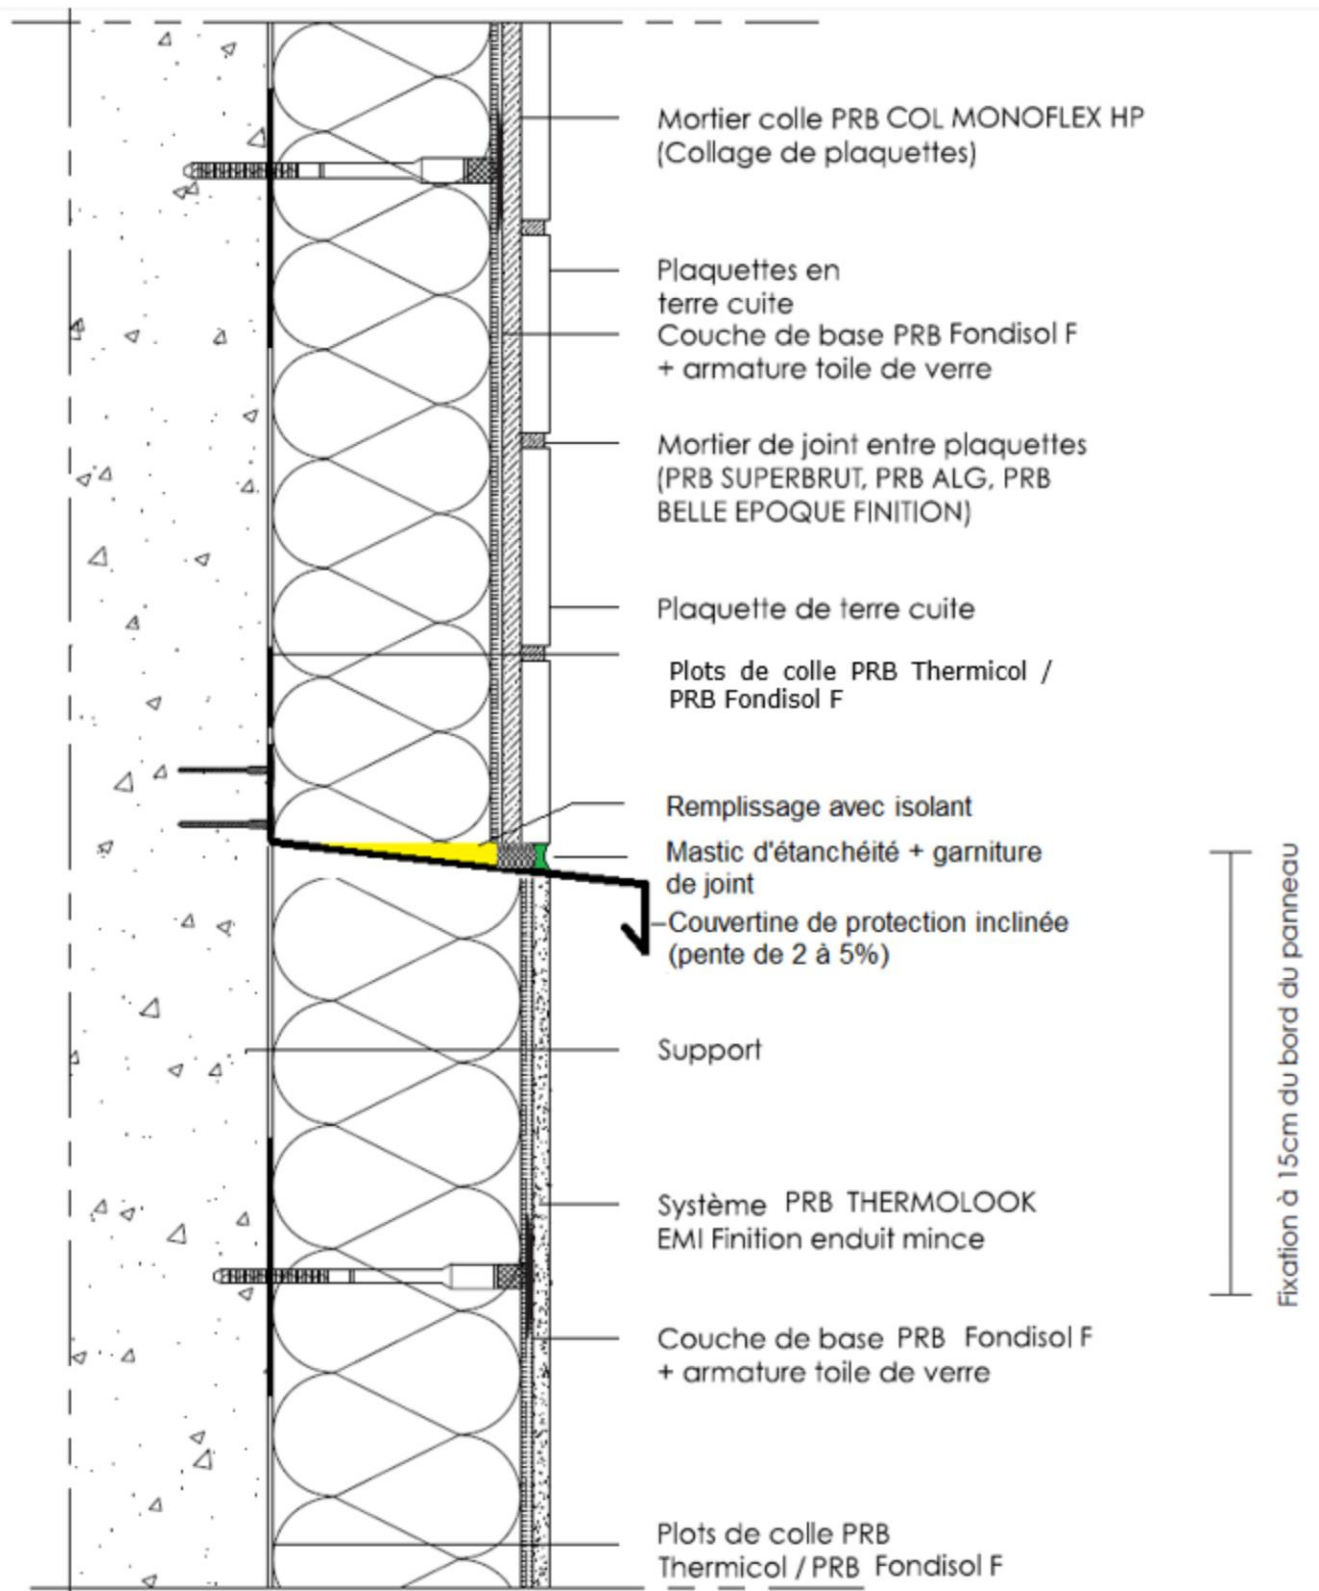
Finition plaquettes de parement en terre cuite : raccordement avec un système d'enduit sur isolant avec utilisation d'une bavette
